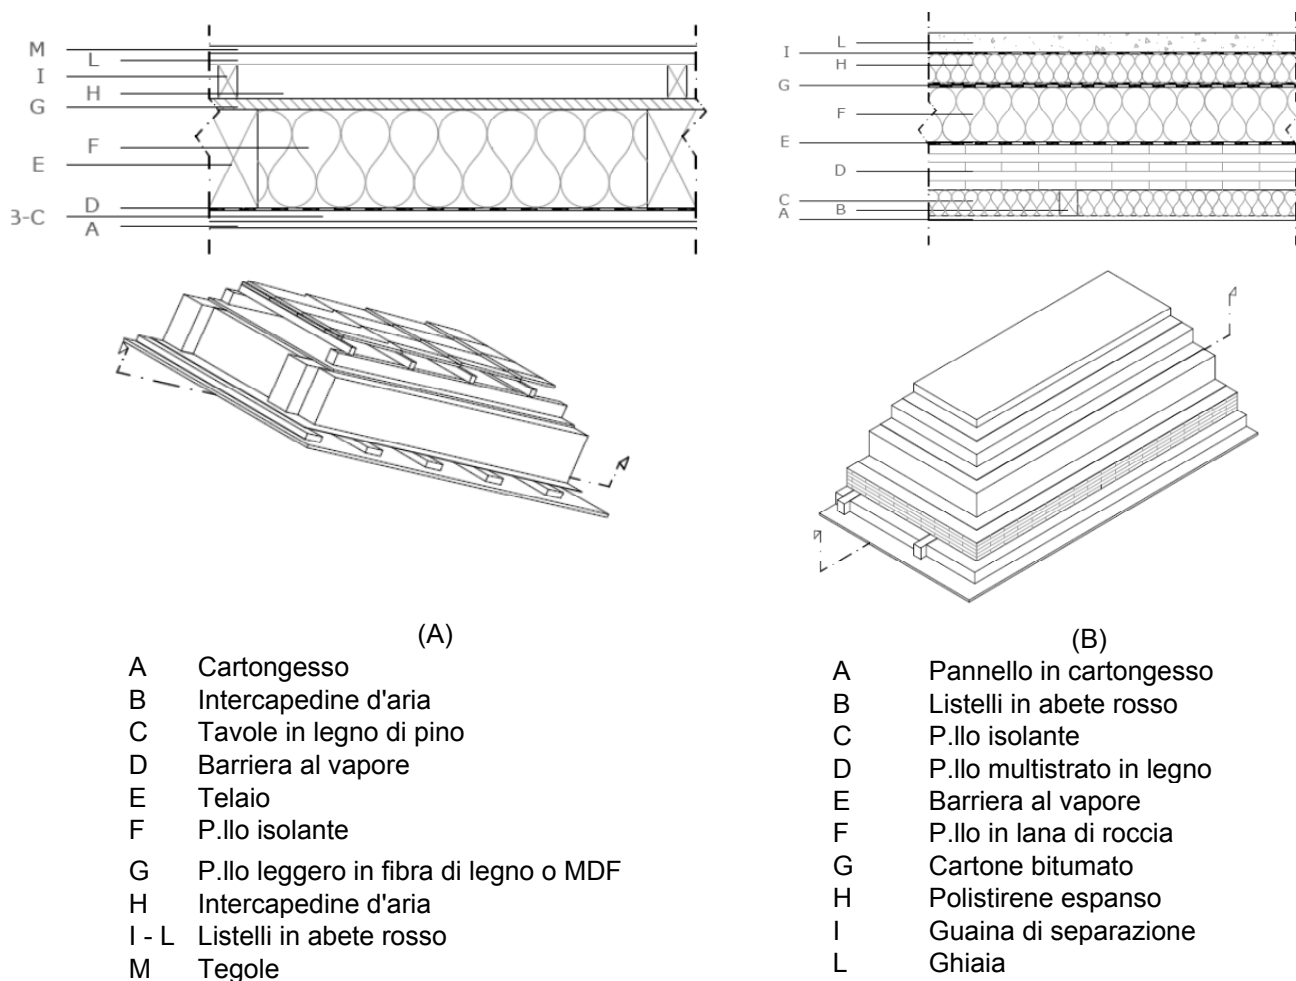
Struttura del tetto a falde 1 (A) e del tetto piano 1 (B).
